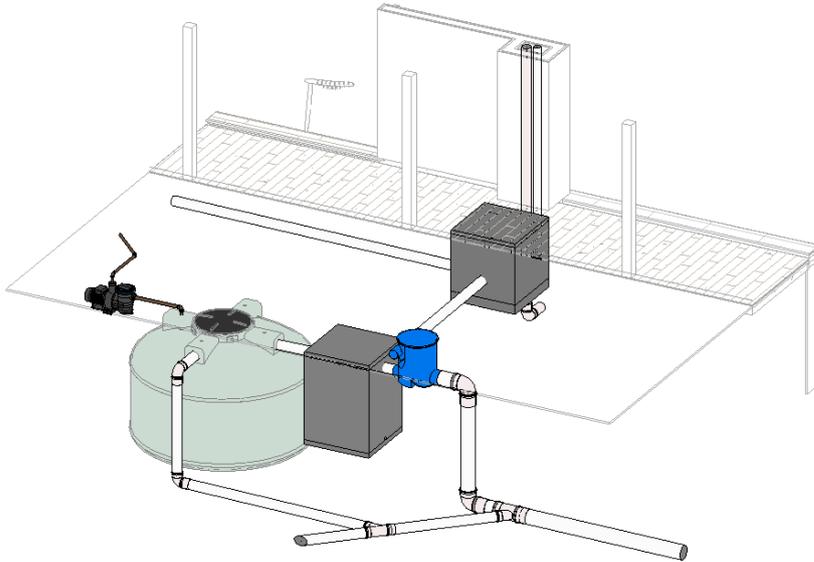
Instalações hidrossanitárias do banheiro da suíte
